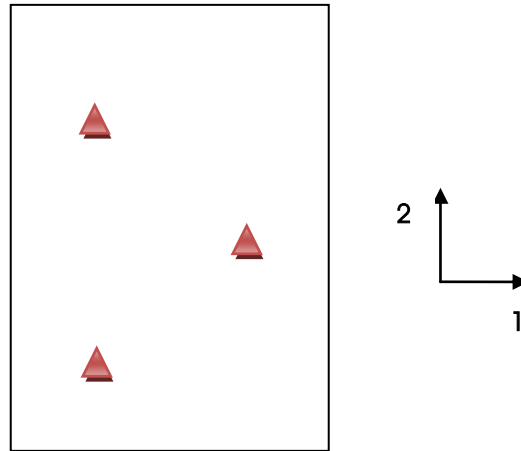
Panel con posición de puntos de apoyo (anclajes) propuesta.
